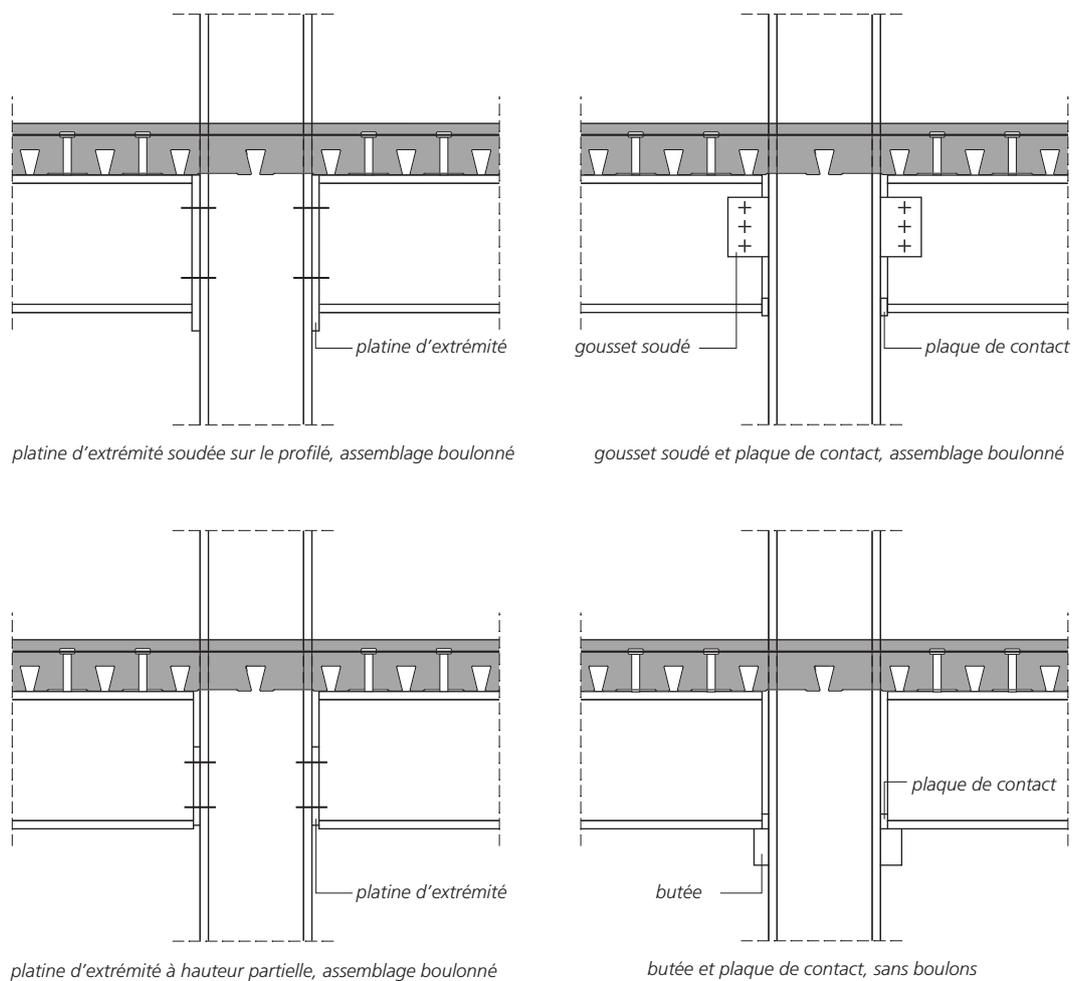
Quelques exemples d'assemblages poutre-poteau en construction mixte
